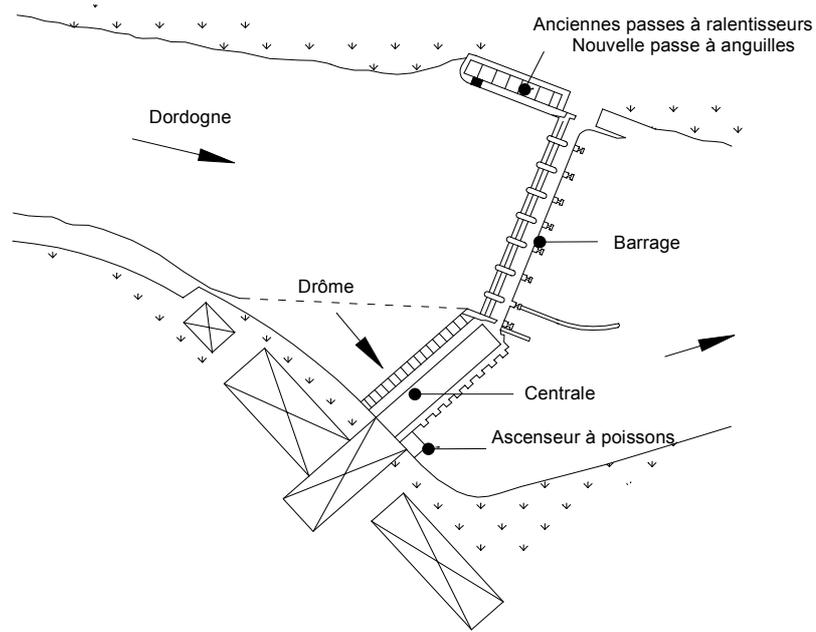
Localisation de la passe à anguilles sur le site de Tuilières
